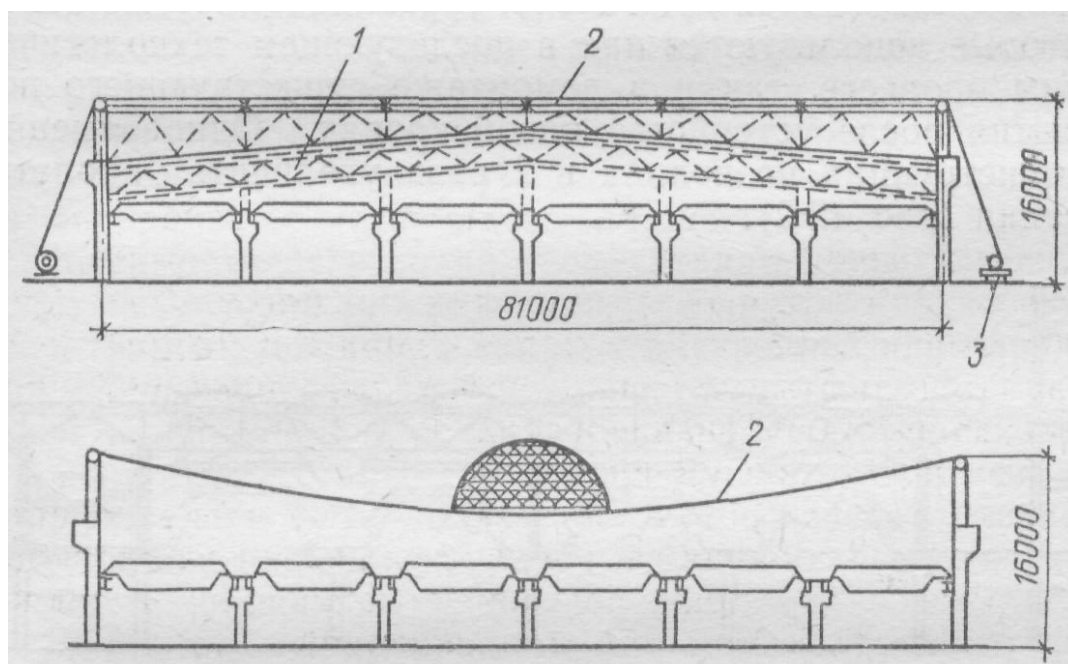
Реконструкция главного корпуса завода «Компрессор»:
